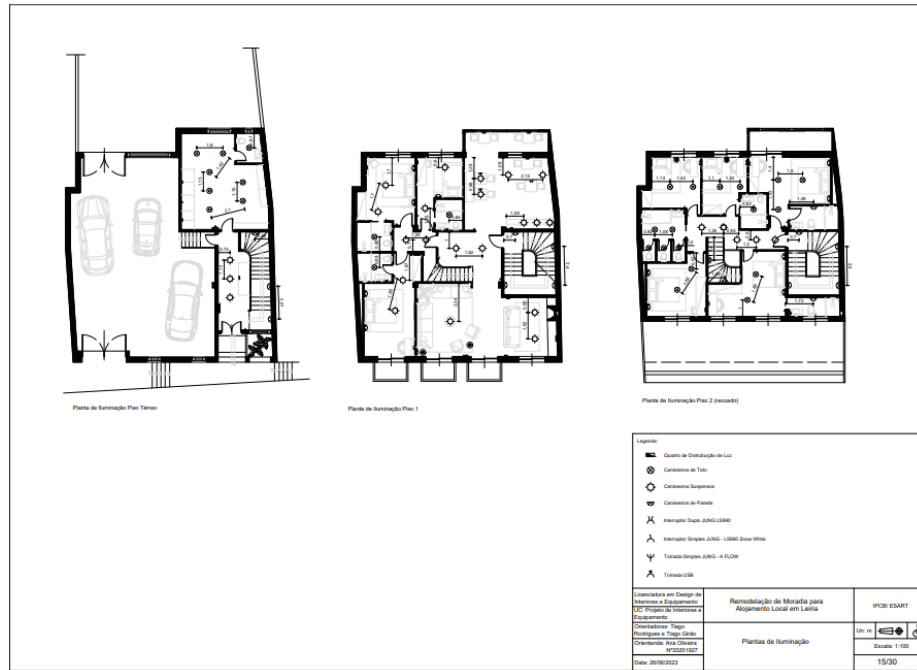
Plantas de Iluminação, Pisos Térreo, 1 e 2, fonte a autora
